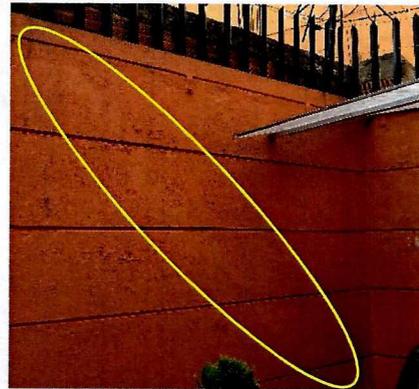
Detalle de fisura reparada, con longitud aproximada de 2 m (apto. 502).
